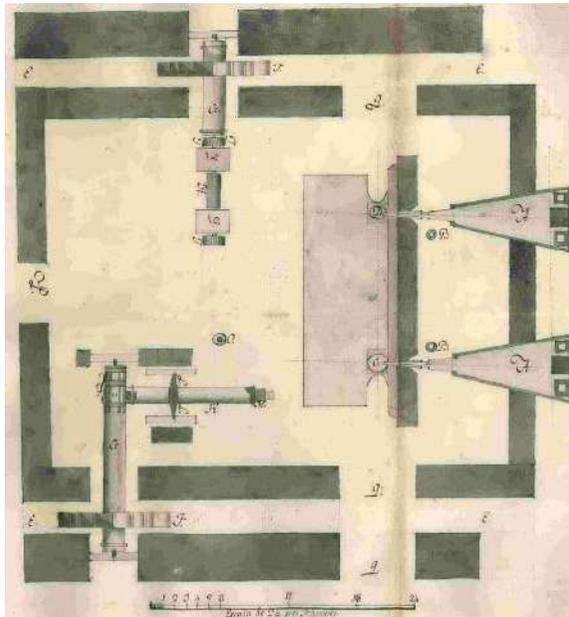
Planta de forja de la Ferrería de Coalcomán. Fuente: Archivo General de la Nación Expediente 009, Minería, Caja 3337. (s.a.).
